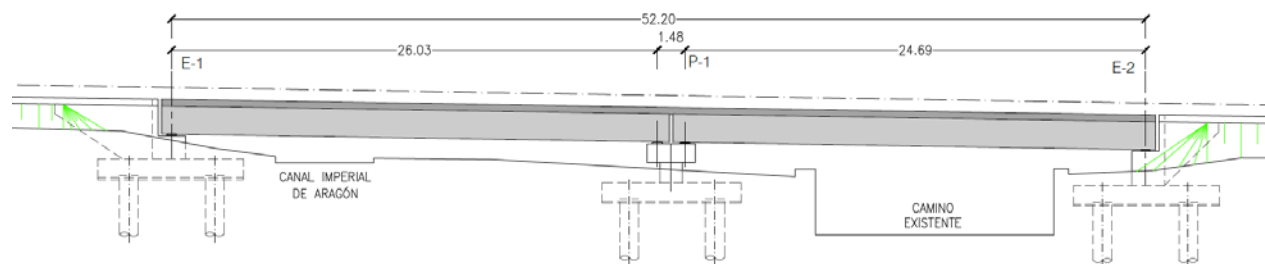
Planta. Viaducto sobre el canal Imperial de Aragón.
